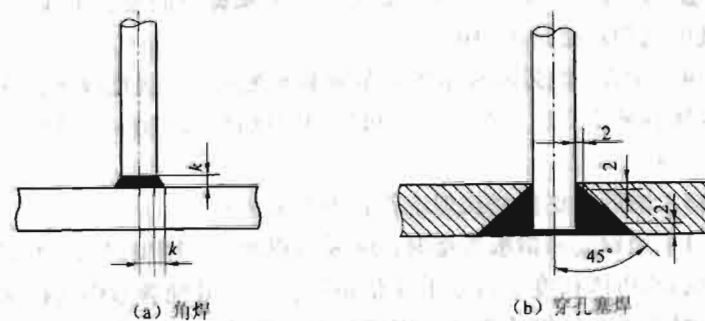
预埋件钢筋电弧焊接头形式 (单位: mm)
